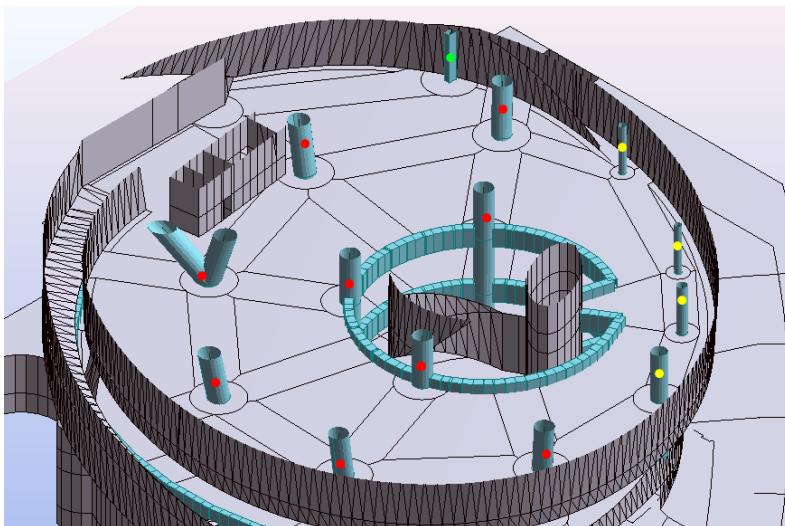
Identificação dos pilares e paredes verticais através do modelo elaborado – piso 2
